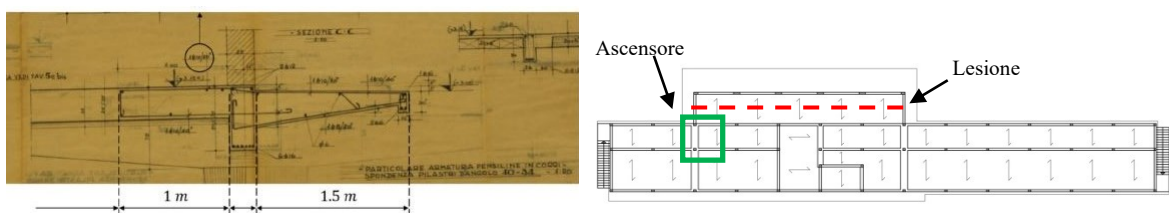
Dettaglio di progetto originale dell'aggetto di un balcone laterale a sinistra (a), e individuazione in pianta della lesione sul solaio del primo piano a destra (b)
